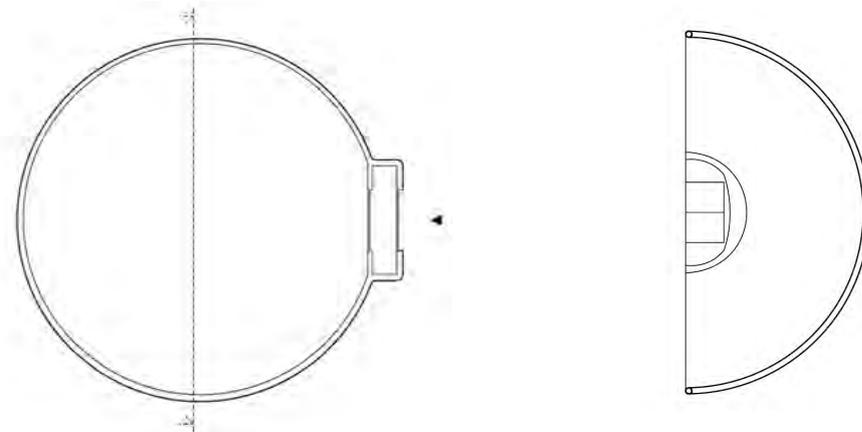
Pneumatische Konstruktion Typ: Dome von Struckmeyer, Grundriß und Schnitt. Die Grundfläche beträgt 491 m². Maßstab 1:500. Eigene Darstellung.
